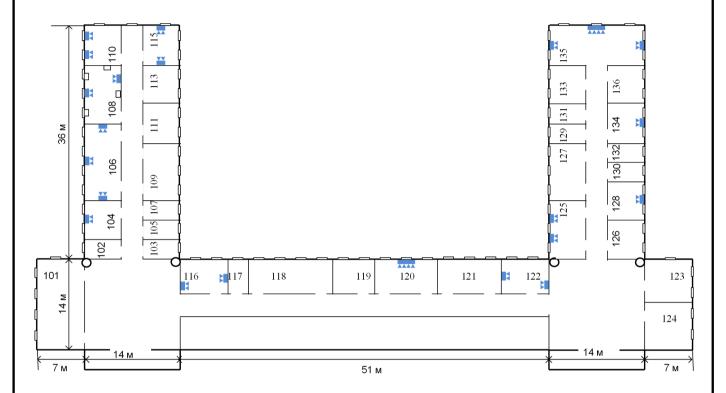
План поверху офісної будівлі з розміщеними на ньому розетками з RJ-45 конекторами
